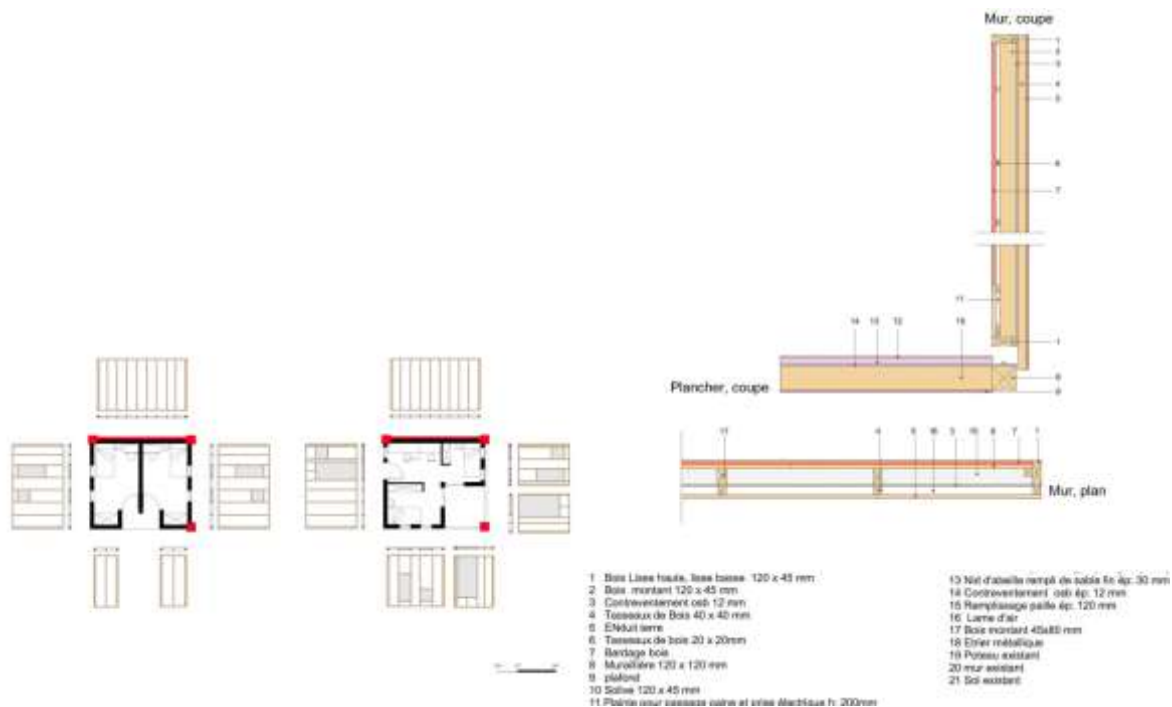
Plans des panneaux d'assemblage pour les chambres et proposition de détails d'exécution.
